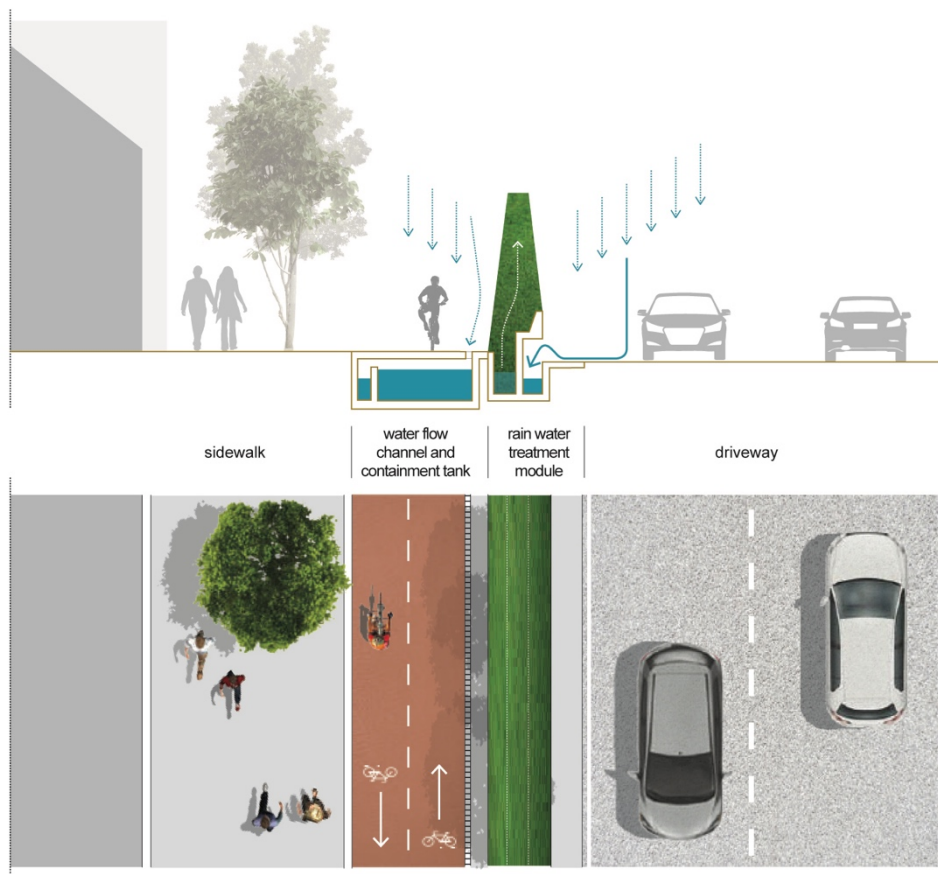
| Sezione e planimetria del progetto di concept di progetto di Marina Bergen Jensen.
